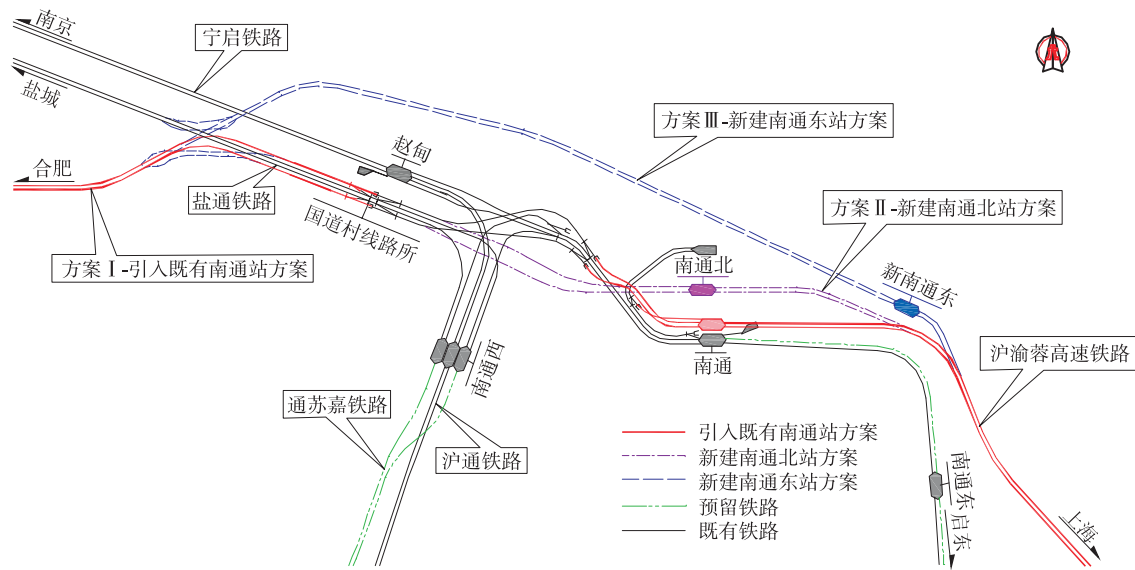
沪渝蓉高铁引入南通地区方案平面布置示意图
